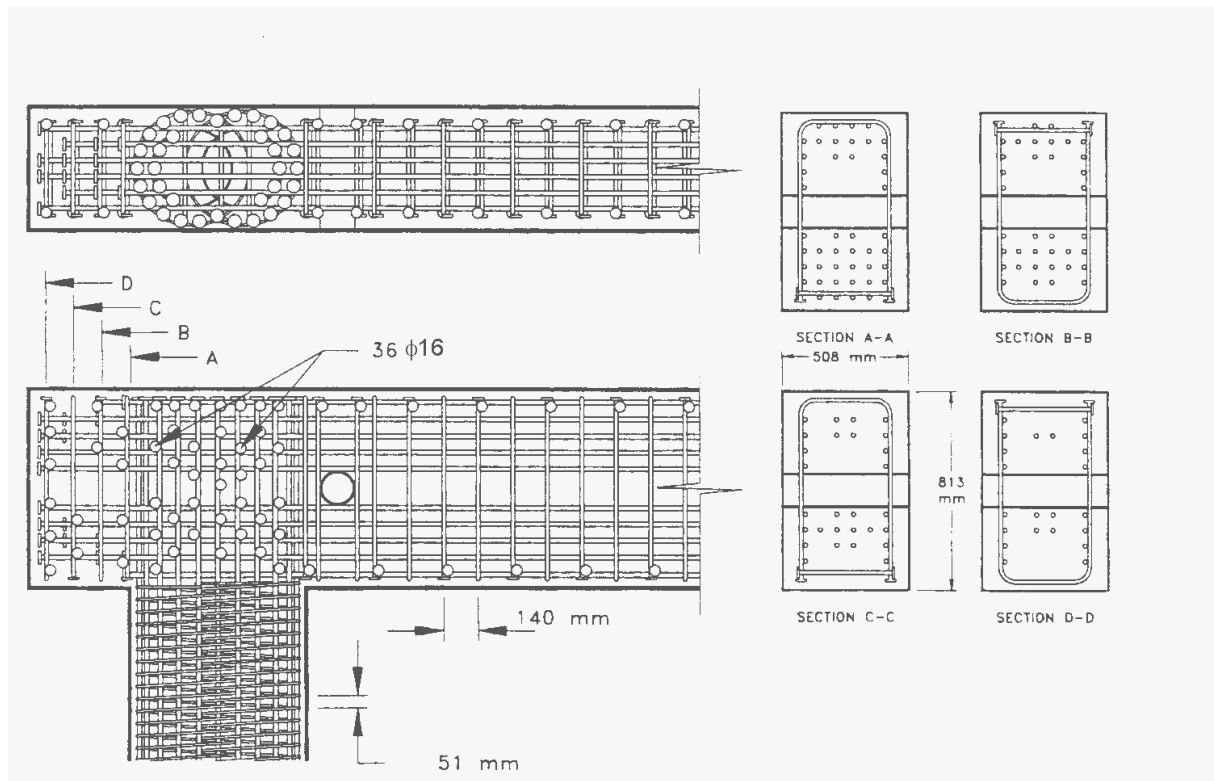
Bewehrungsplan des Brückenlagers der Versuche von Ingham, Priestley und Seible [1996]
